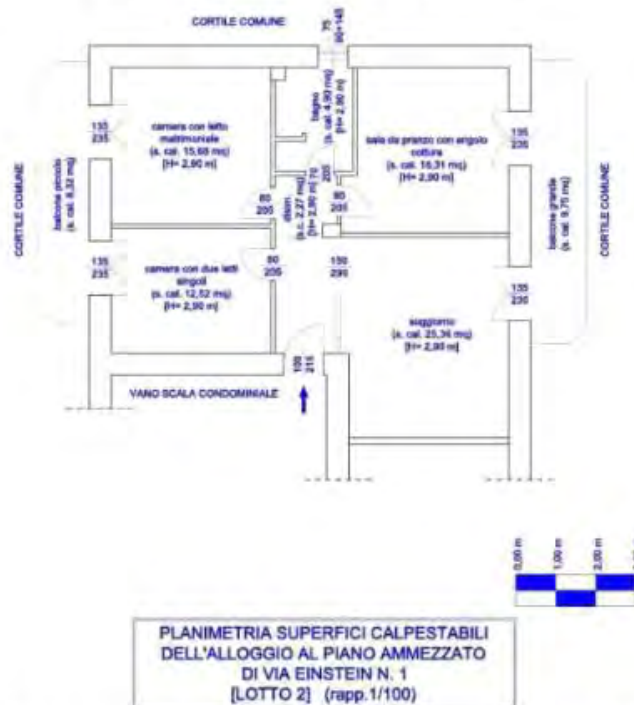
Planimetria urbanistica alloggio al piano ammezzato (26.6.2018)
